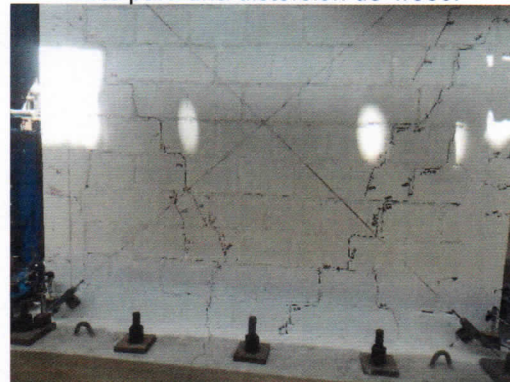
Continuación de grietas diagonales en el lado Este de la cara Norte para una distorsión de 1/800.
